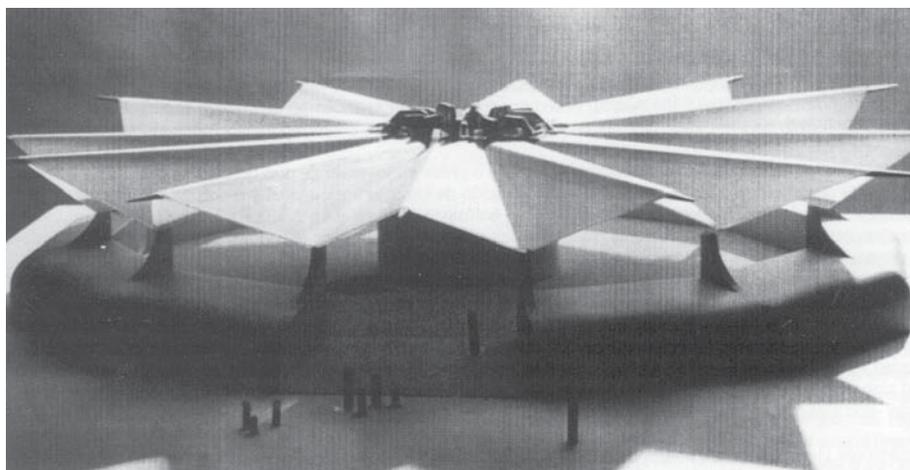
Pabellón suizo. Cubierta desplegada. Expo-Sevilla 92. Hossdorf.
